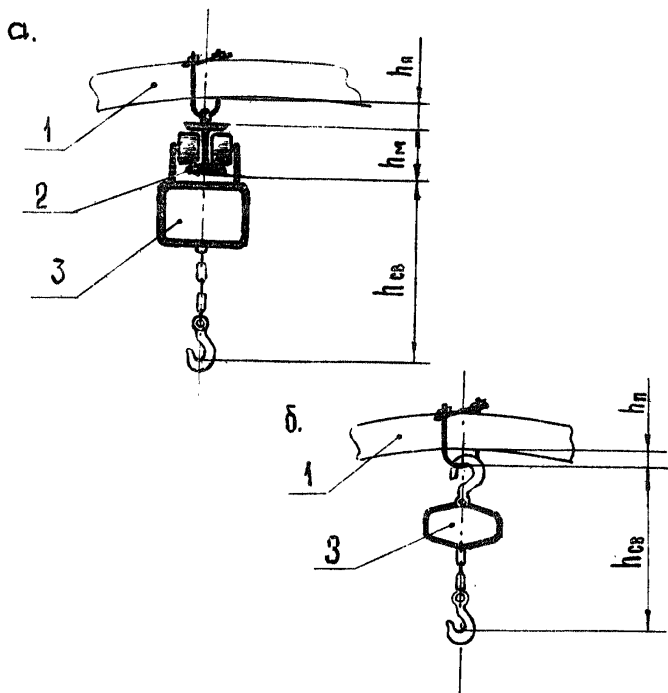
Схема узла подвешивания грузоподъемного оборудования в горной выработке:
